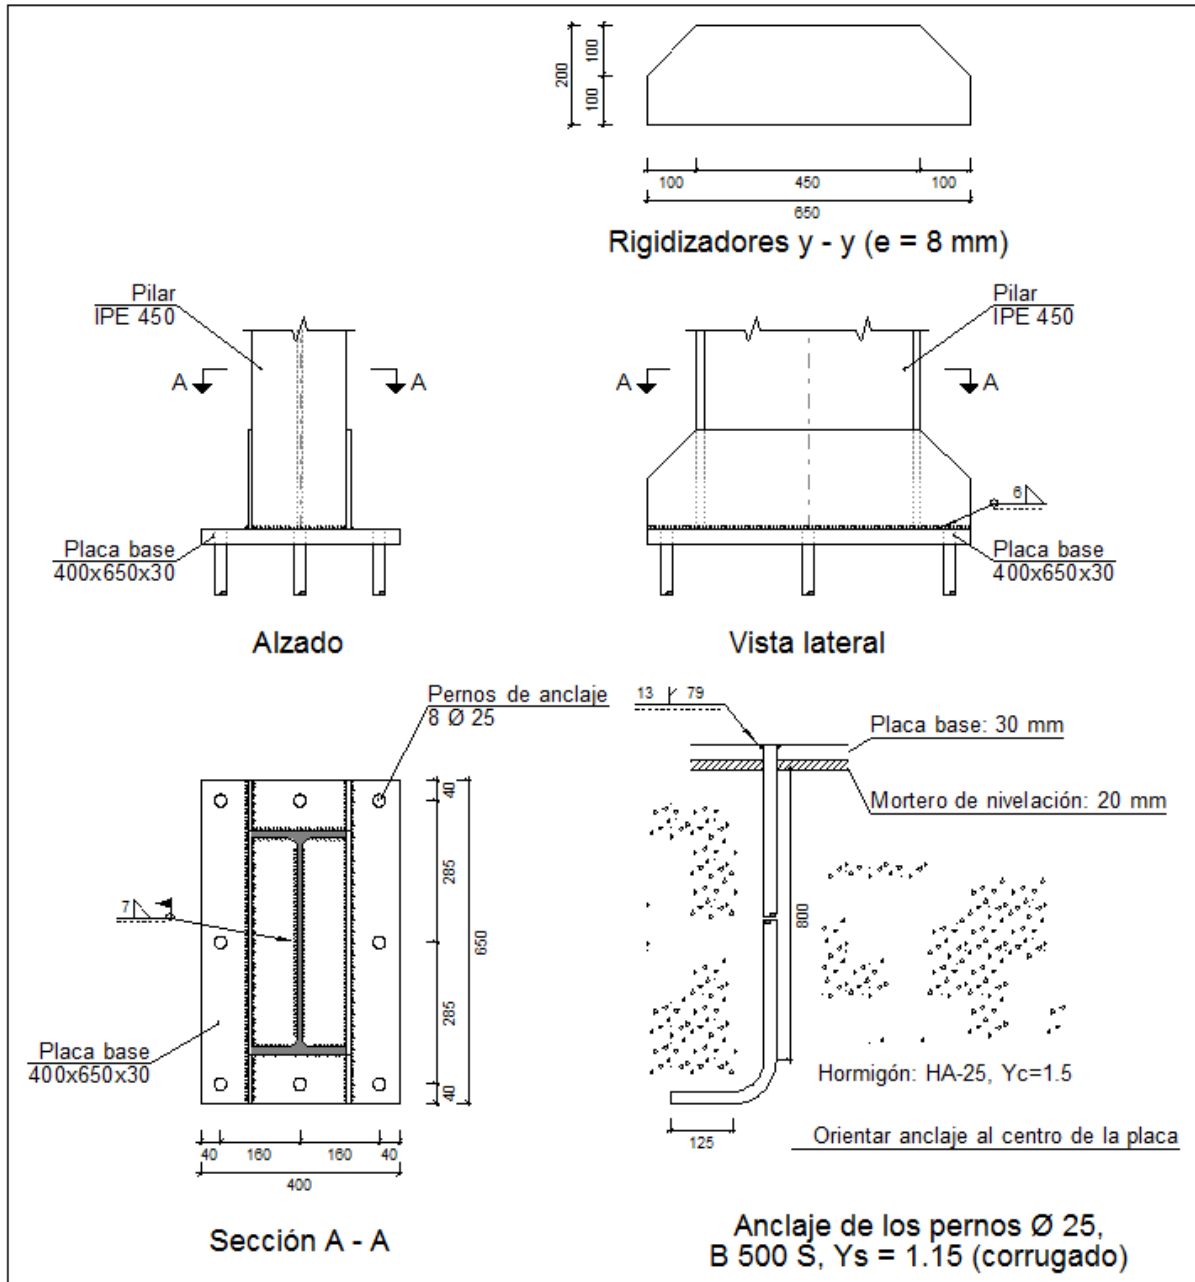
Detalle de placa de anclaje, tipo 1 (CYPE)
